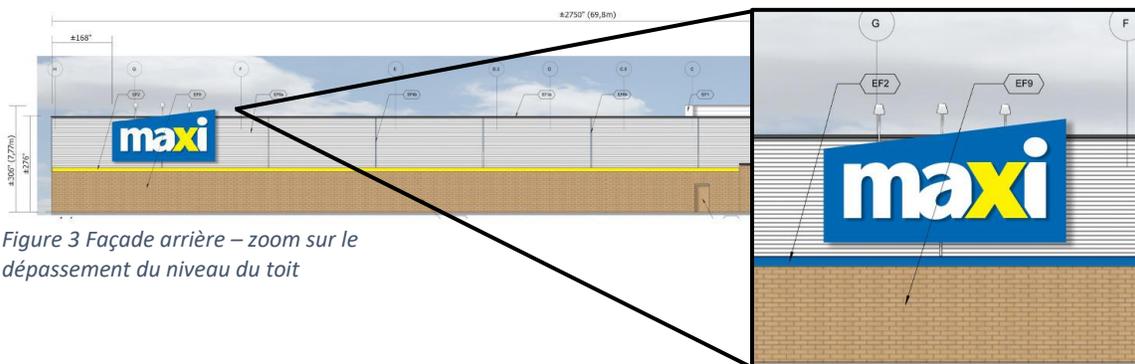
Façade arrière – zoom sur le dépassement du niveau du toit
